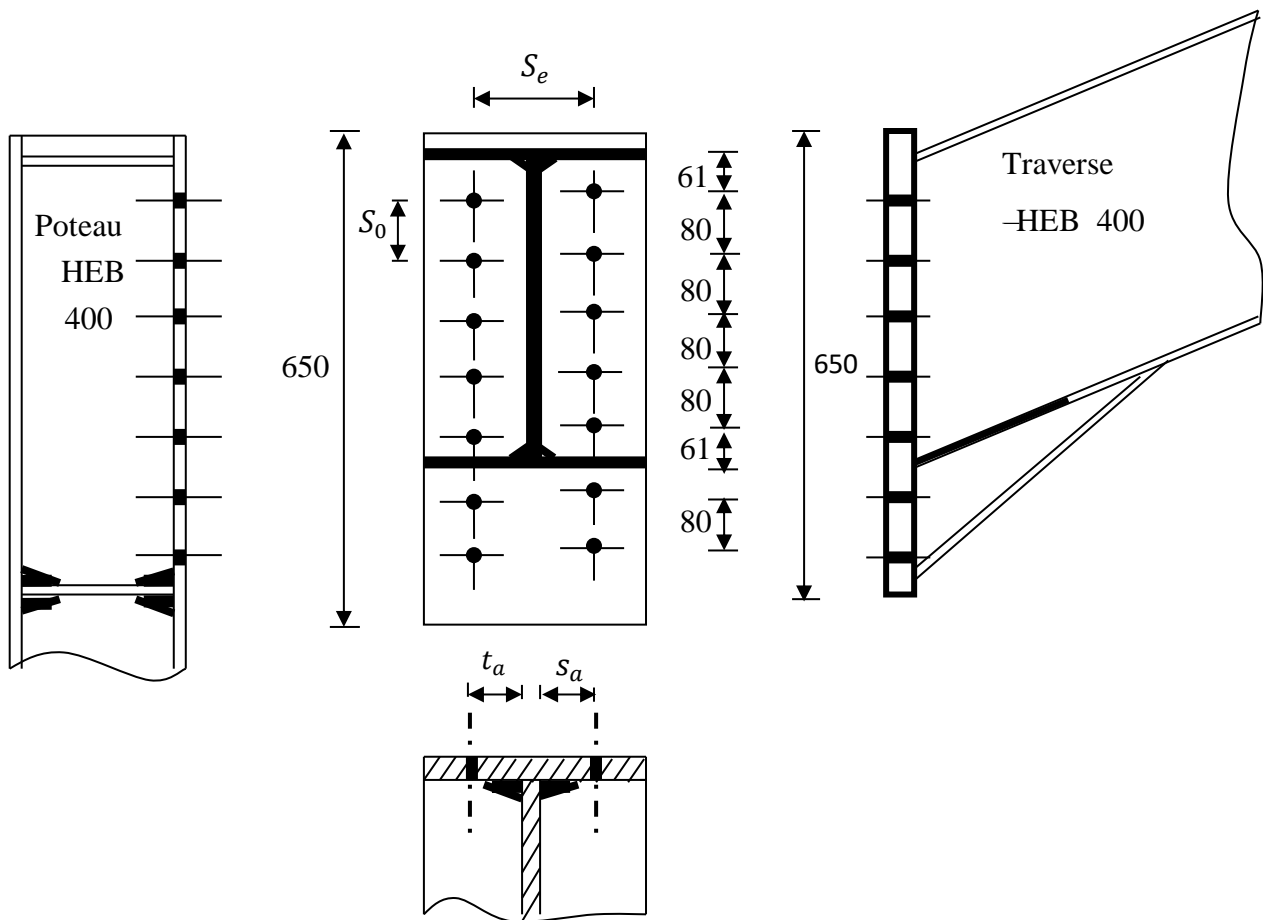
Schéma d'assemblage (poteau-traverse)
